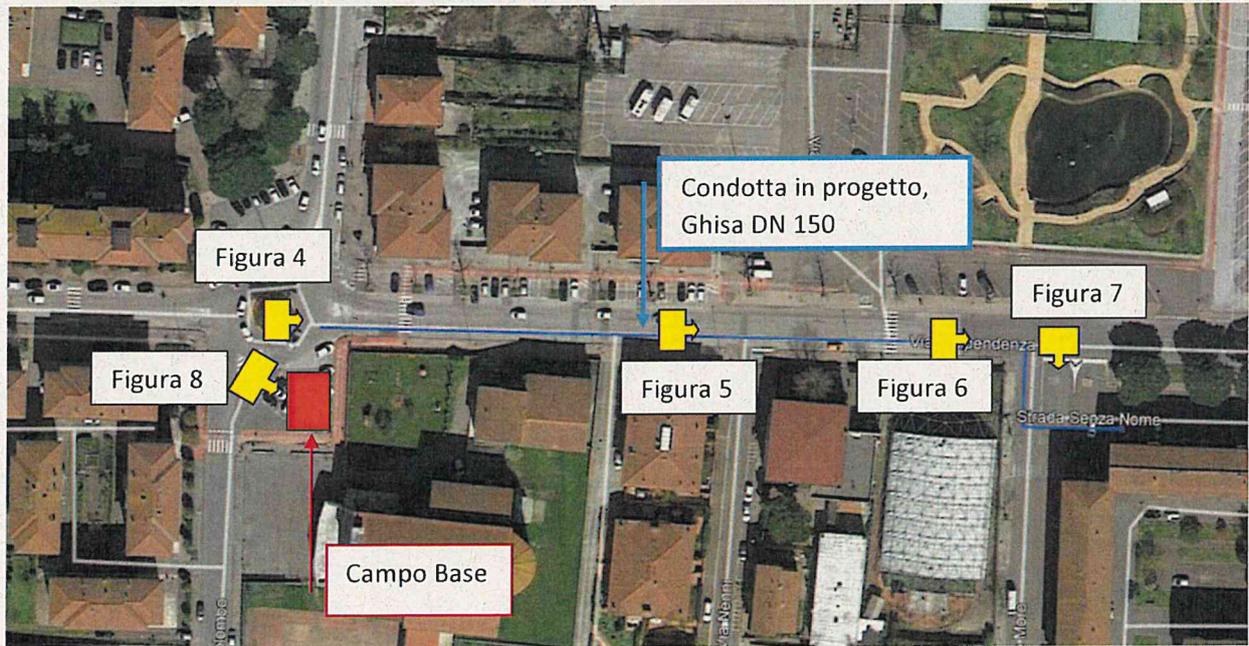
Planimetria intervento su base aerofotogrammetrico, CAMPO BASE
